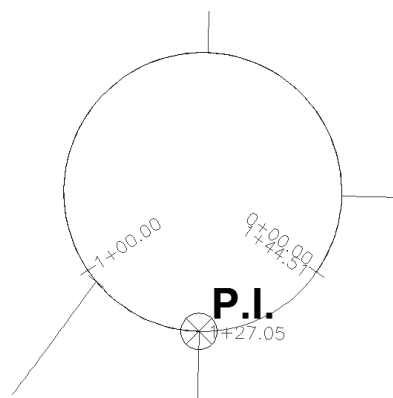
Intersecção em Planta entre o eixo do Restabelecimento 2 e a Rotunda B
